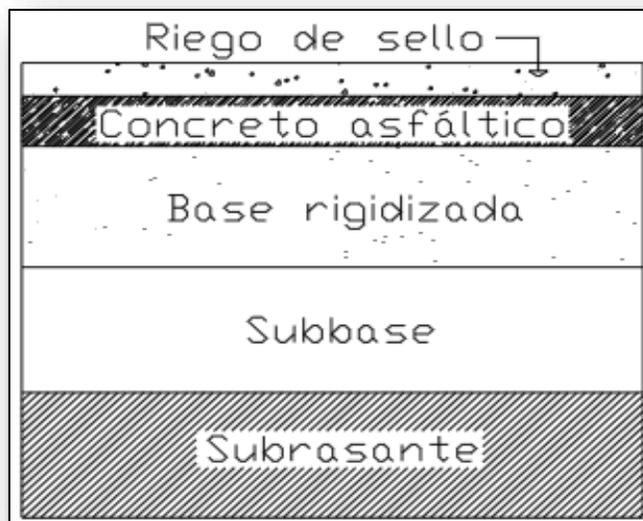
Estructura Pavimento Flexible de Concreto Asfáltico
